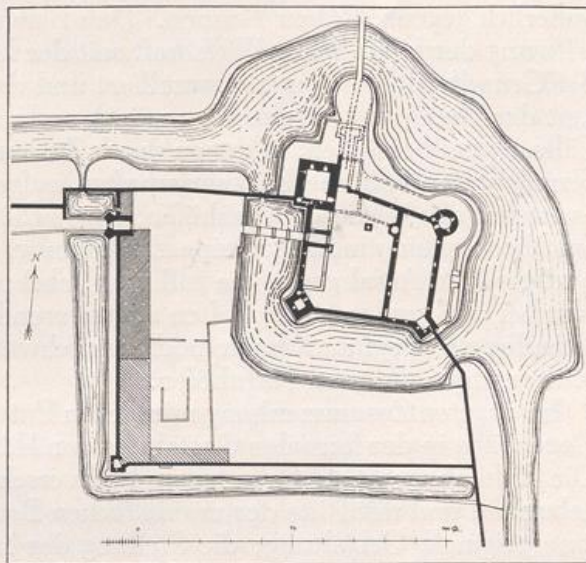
Die kurköln. Landesburg Lechenich, Lageplan.
